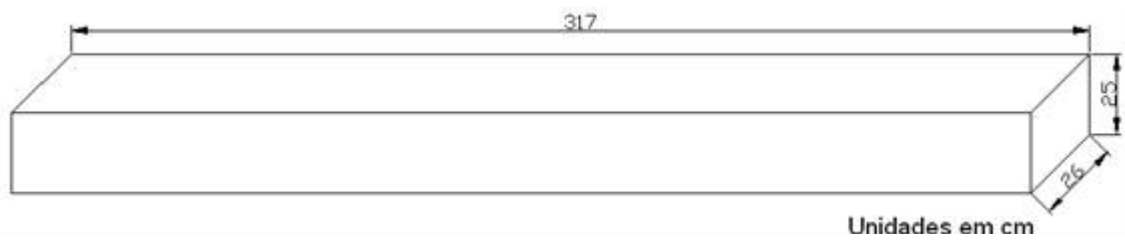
Dimensões da viga do Ensaio 2.
